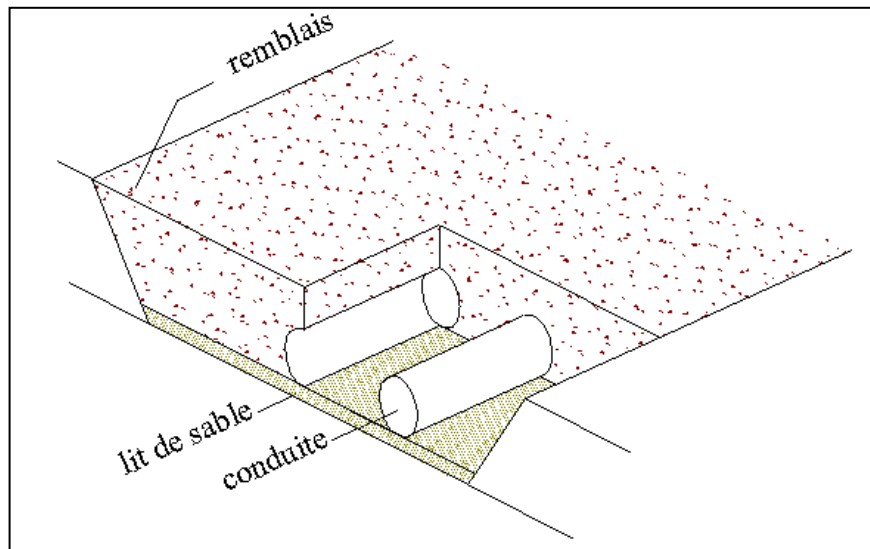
Coupe transversale d'une tranchée avec la mise en place de la conduite
